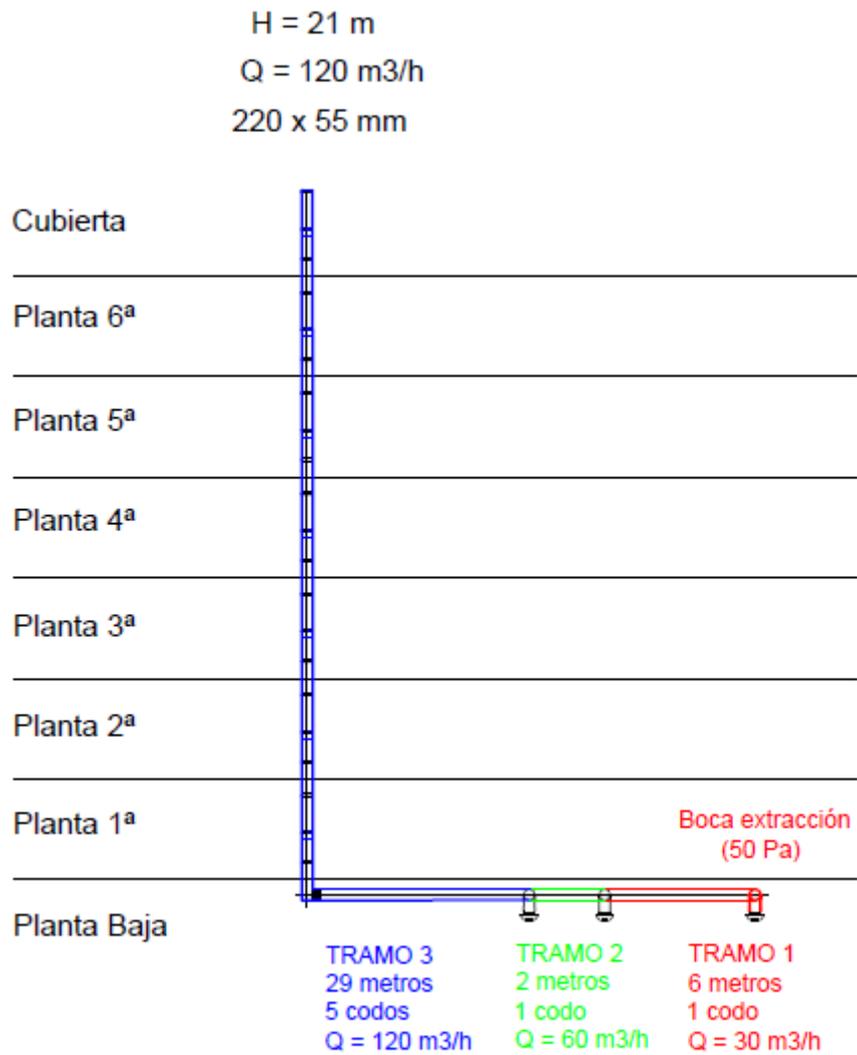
Esquema cálculo de pérdidas de carga en la situación más desfavorable para el caso individual.
